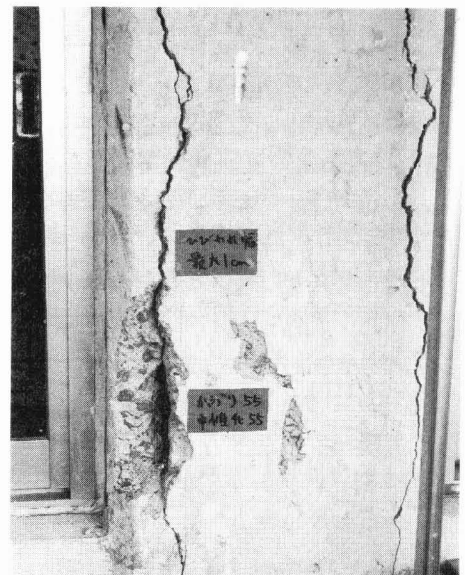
古島団地柱主筋に沿った縦ひび割れの損傷状況
